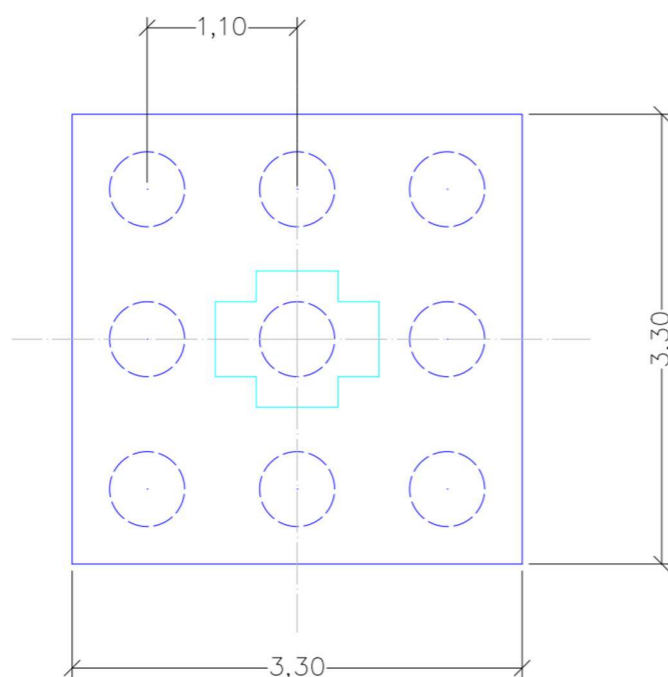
Dimensiones y disposición de los pilotes de la cimentación de la pila P9 en planta, en metros.
